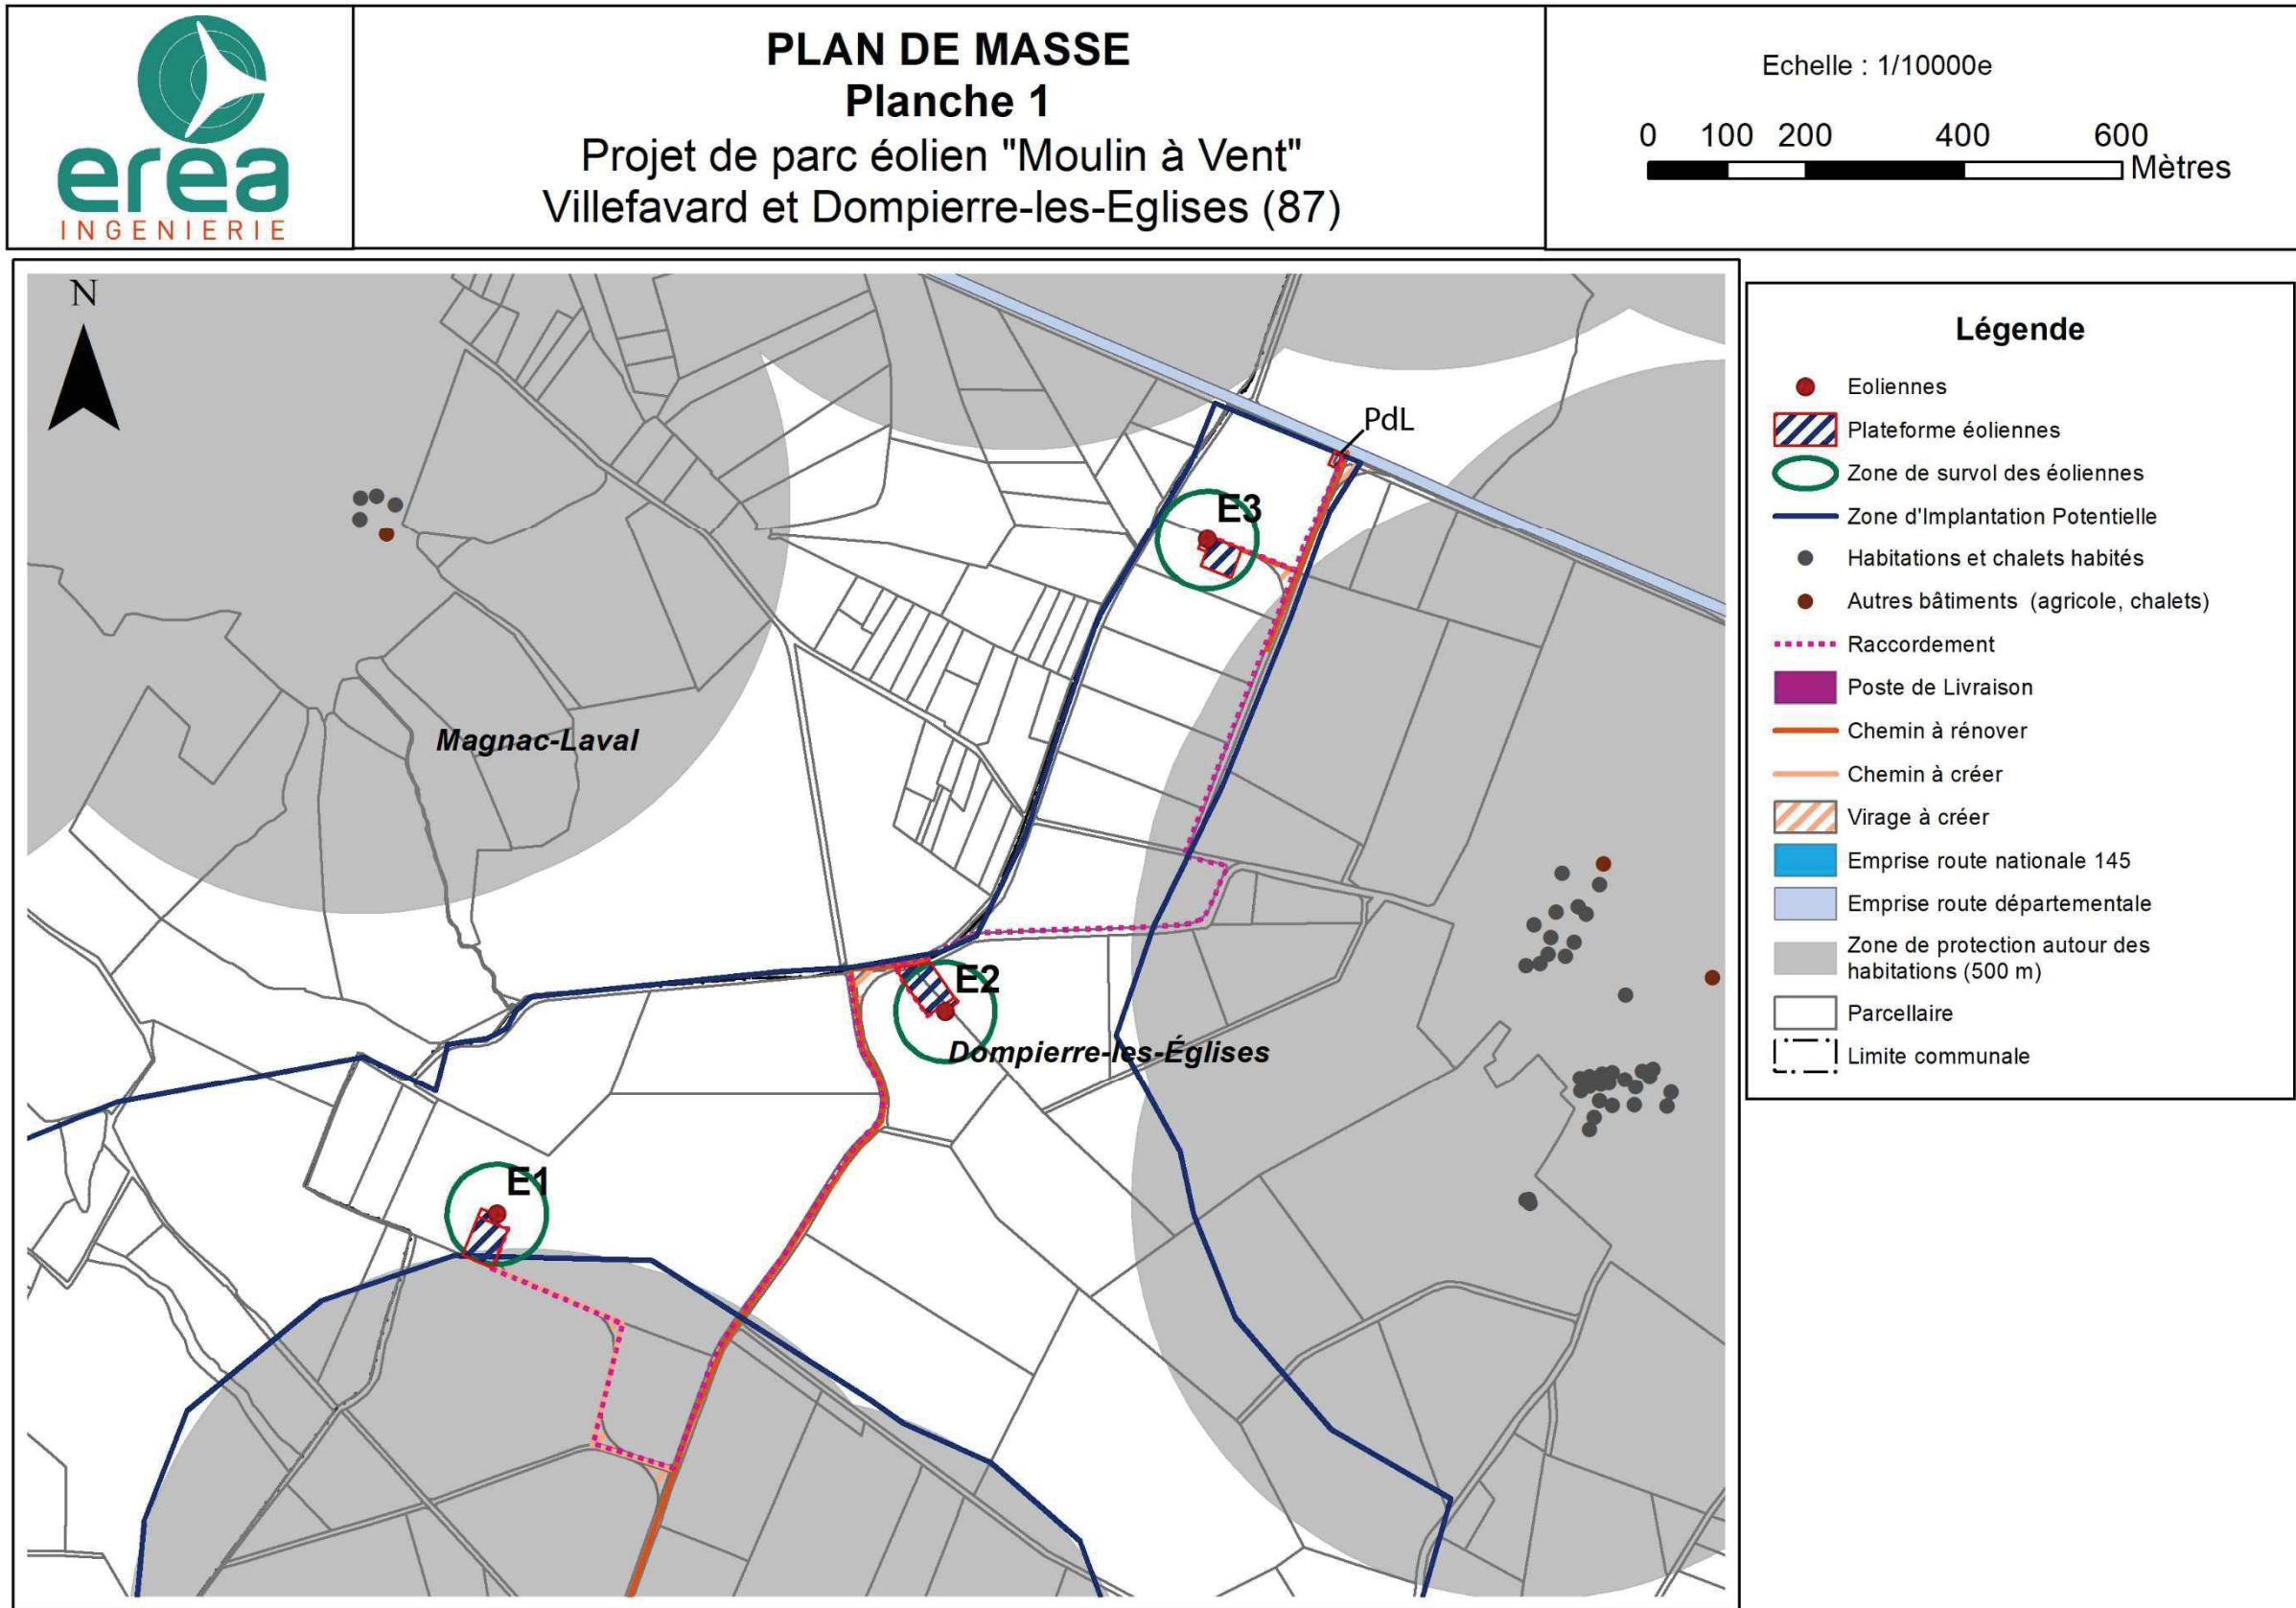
Plan de masse du projet (zoom sur les éoliennes E1 à E3)
